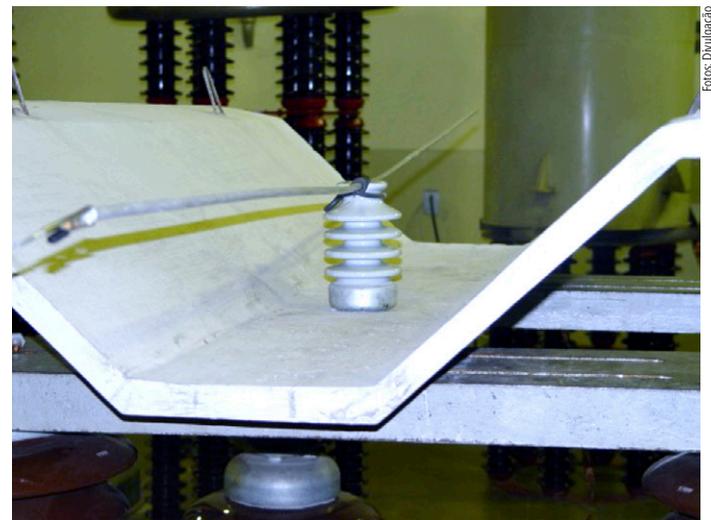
Ensaio realizado em isolador sobre a telha de concreto protendido
